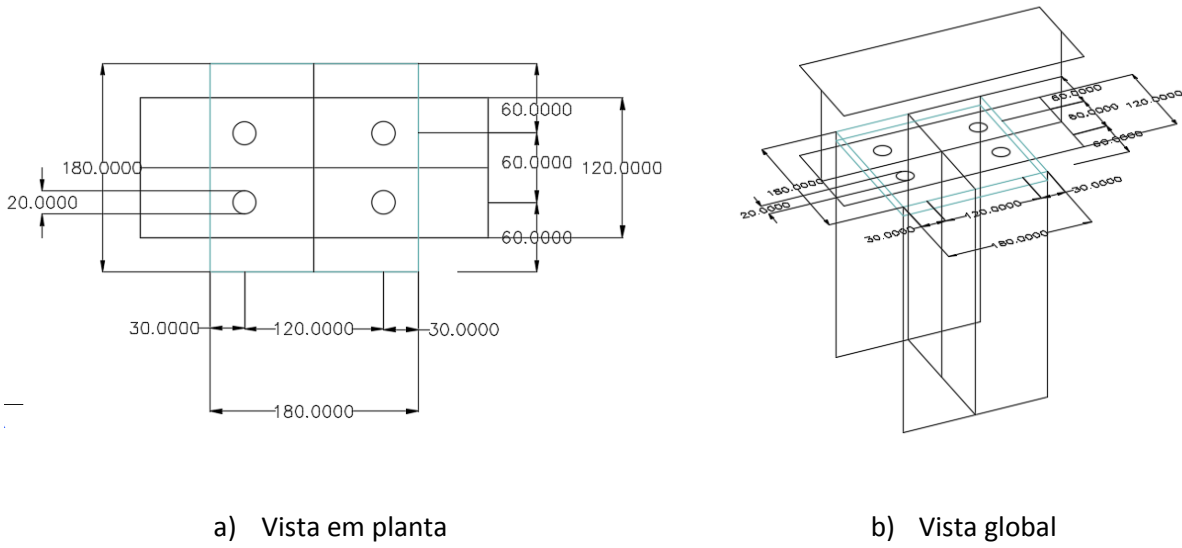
Pormenor construtivo da ligação dos pilares da fundação B com as cordas inferiores da treliça
